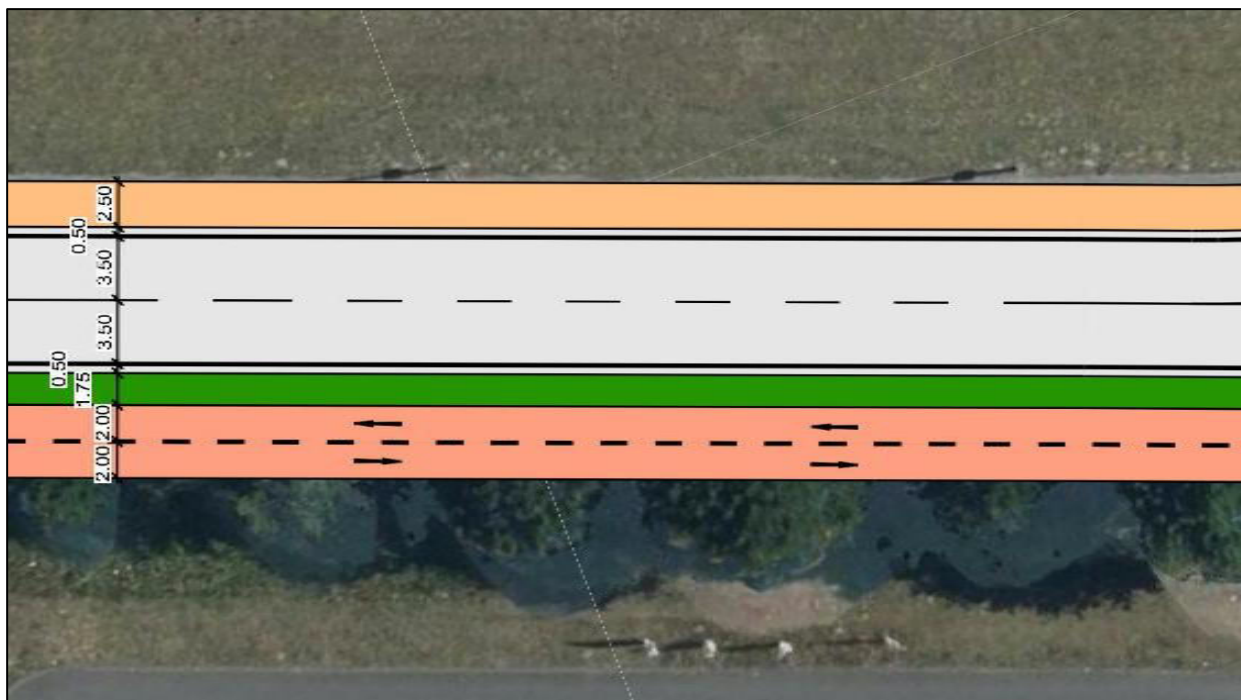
Lageplanausschnitt der Variante „Einseitiger Zweirichtungsradweg“ [1]
